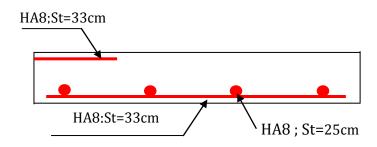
Vue en coupe du ferraillage de la dalle sur deux appuis
